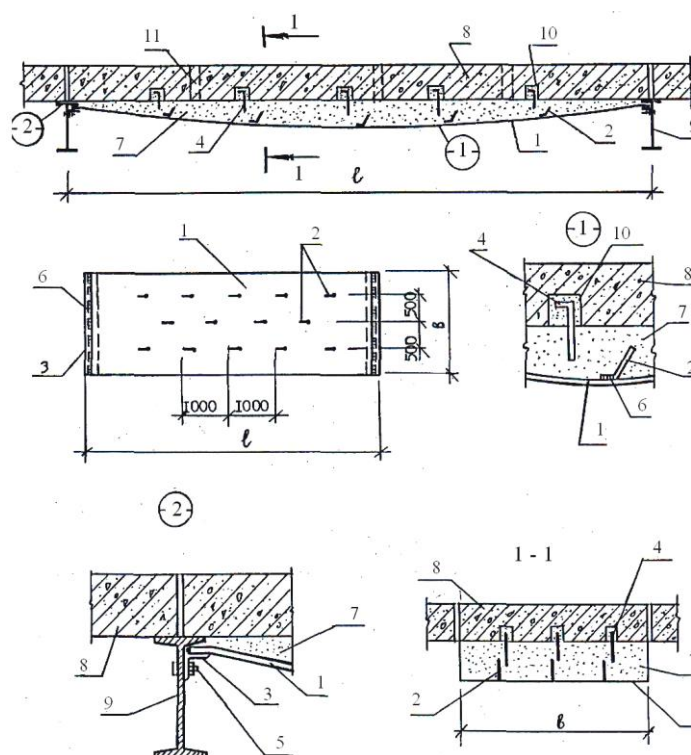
Усиление сборных плит перекрытия с помощью изогнутого стального листа:
